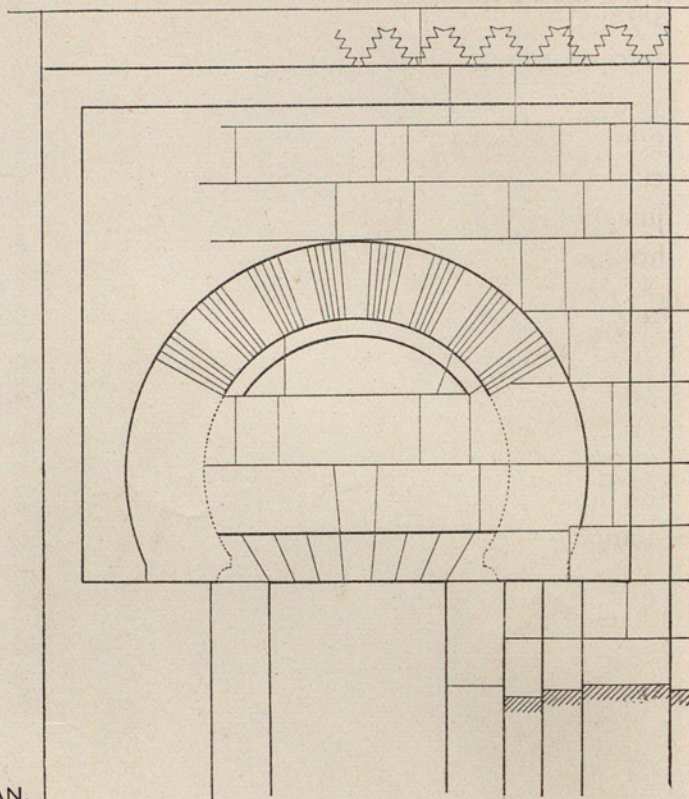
FACHADA INTERIOR DE LA PUERTA DE SAN ESTEBAN.
